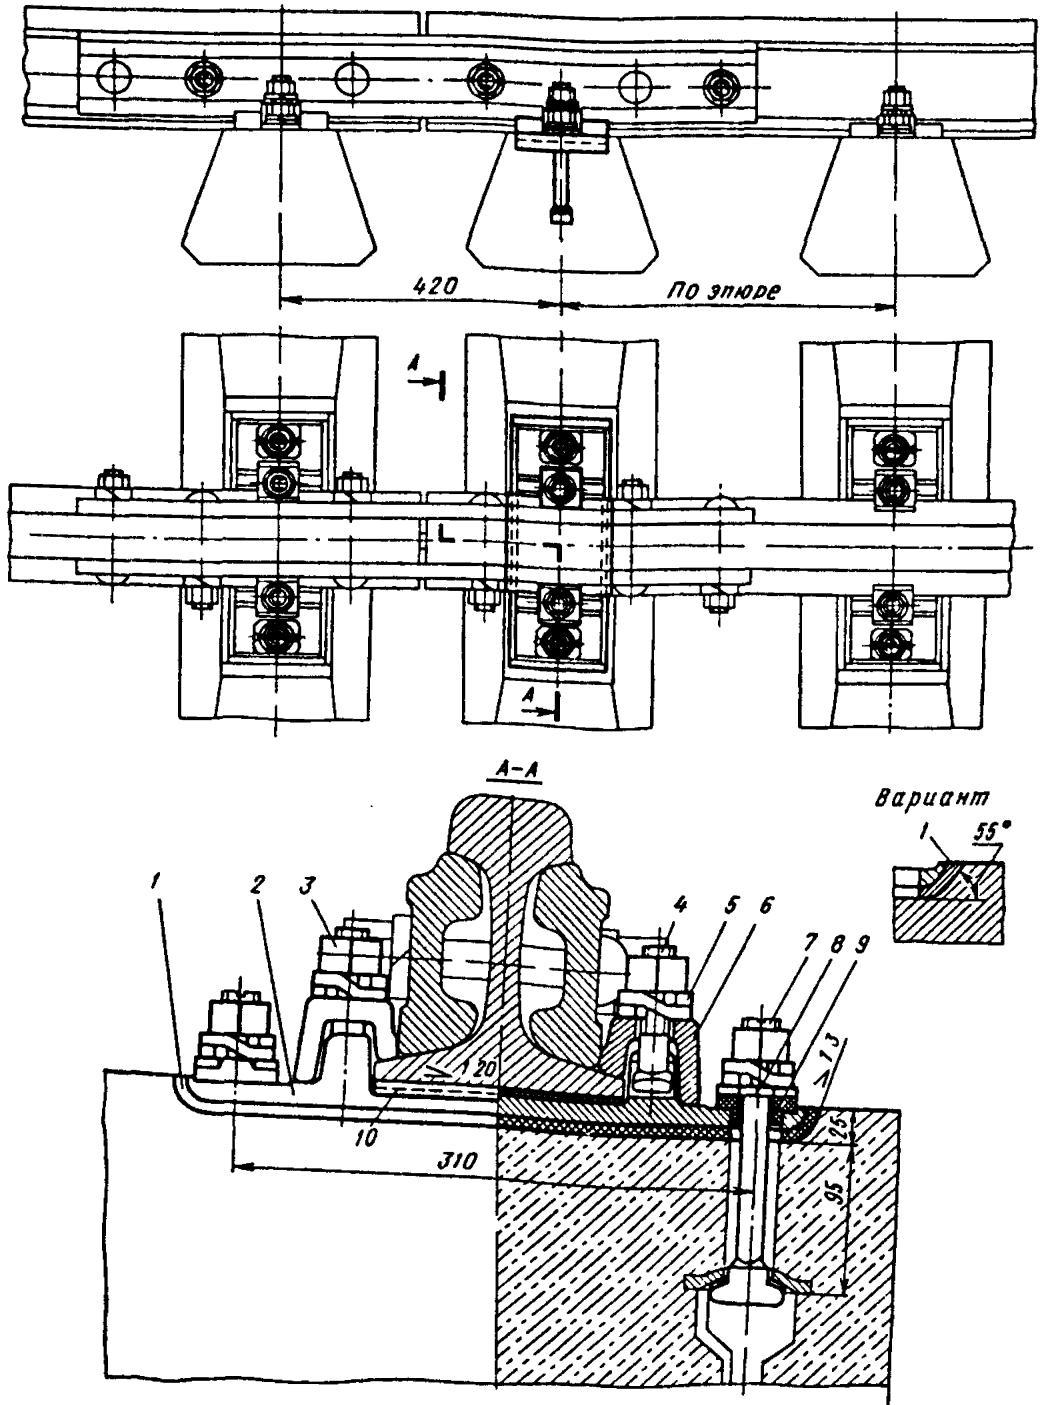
Стыковое и промежуточное скрепление КБ65 на железобетонных шпалах с рельсами Р65 и Р75:
